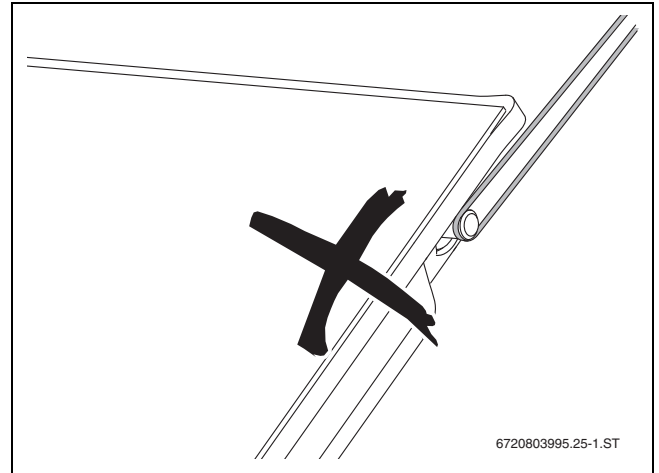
Запрещается использовать штуцеры коллектора в качестве вспомогательного приспособления для транспортировки
